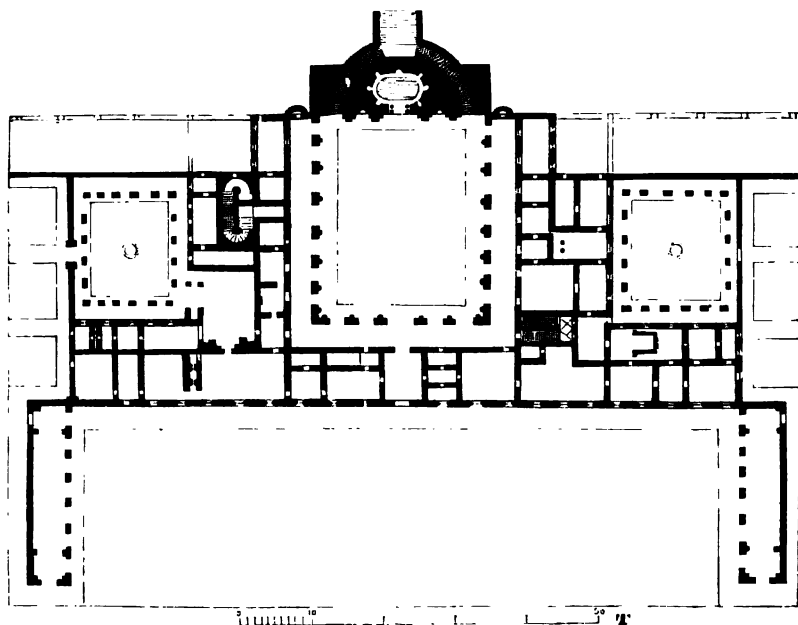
Palazzo Pitti zu Florenz. Grundriß.
